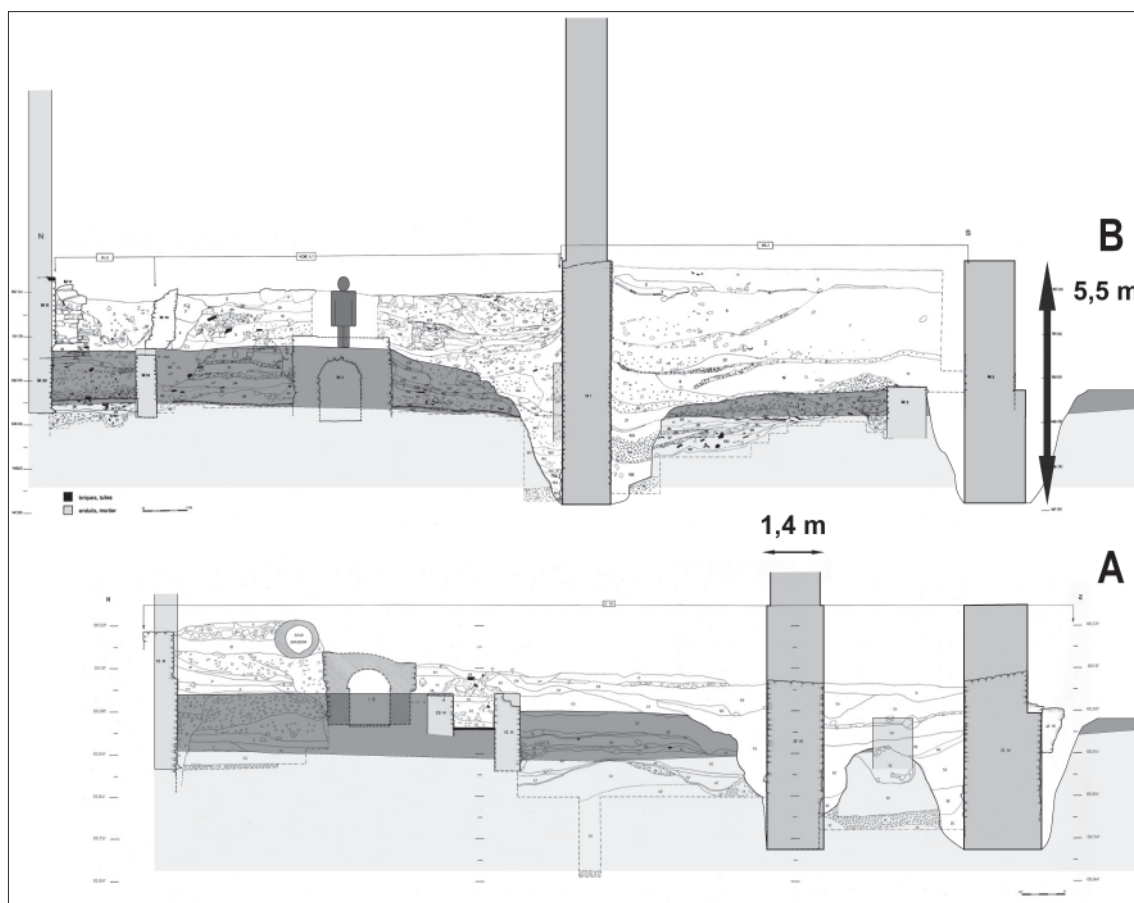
Les fondations du Portique Nord. (J.-L. Prisset)
